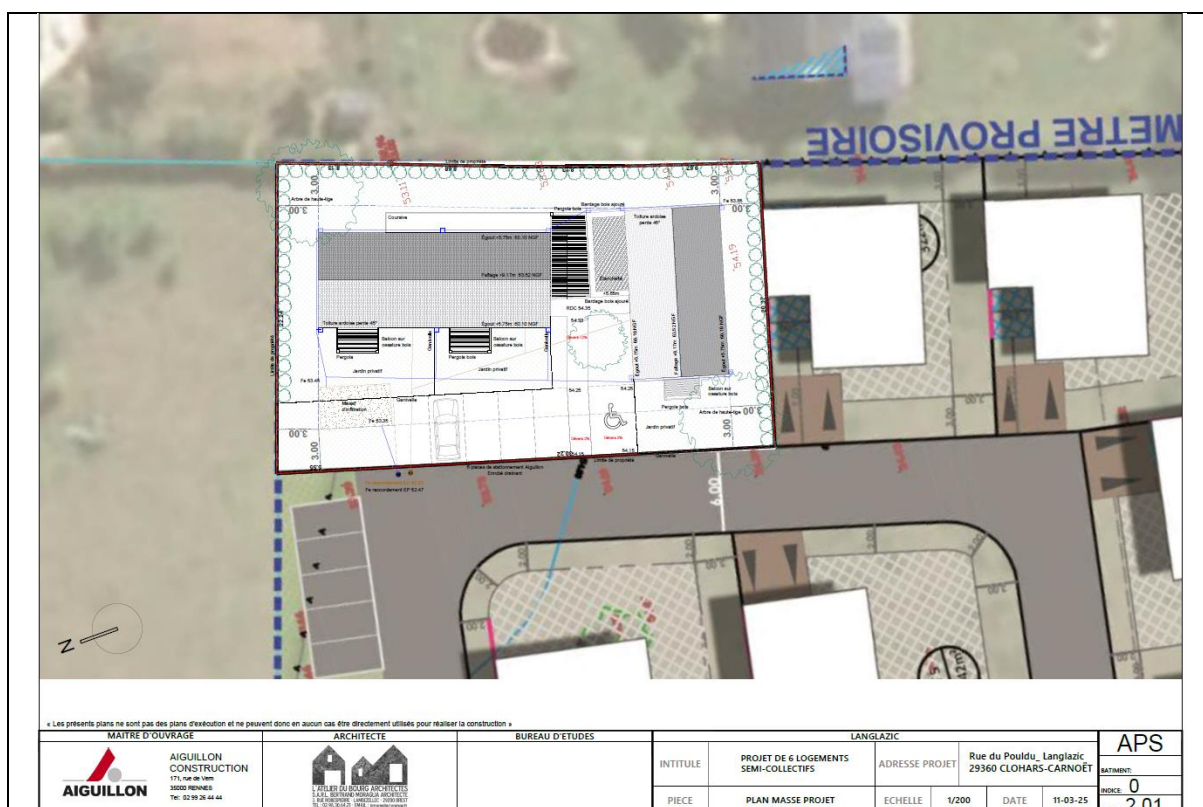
Plan masse projet (Atelier du bourg architecte – 03/2025)
